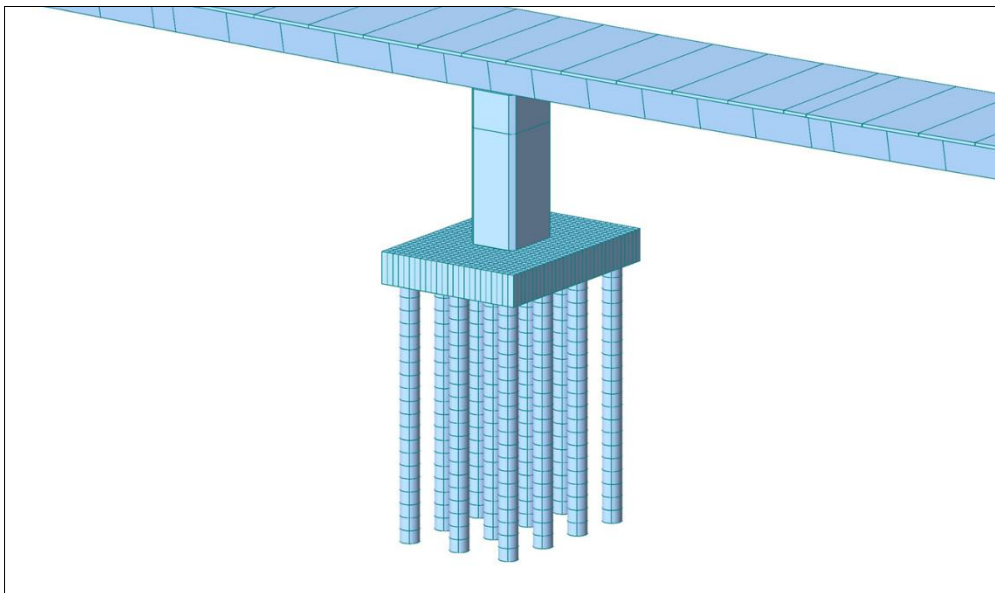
Vue en 3D de l'EF de la semelle et les pieux sur Midas
